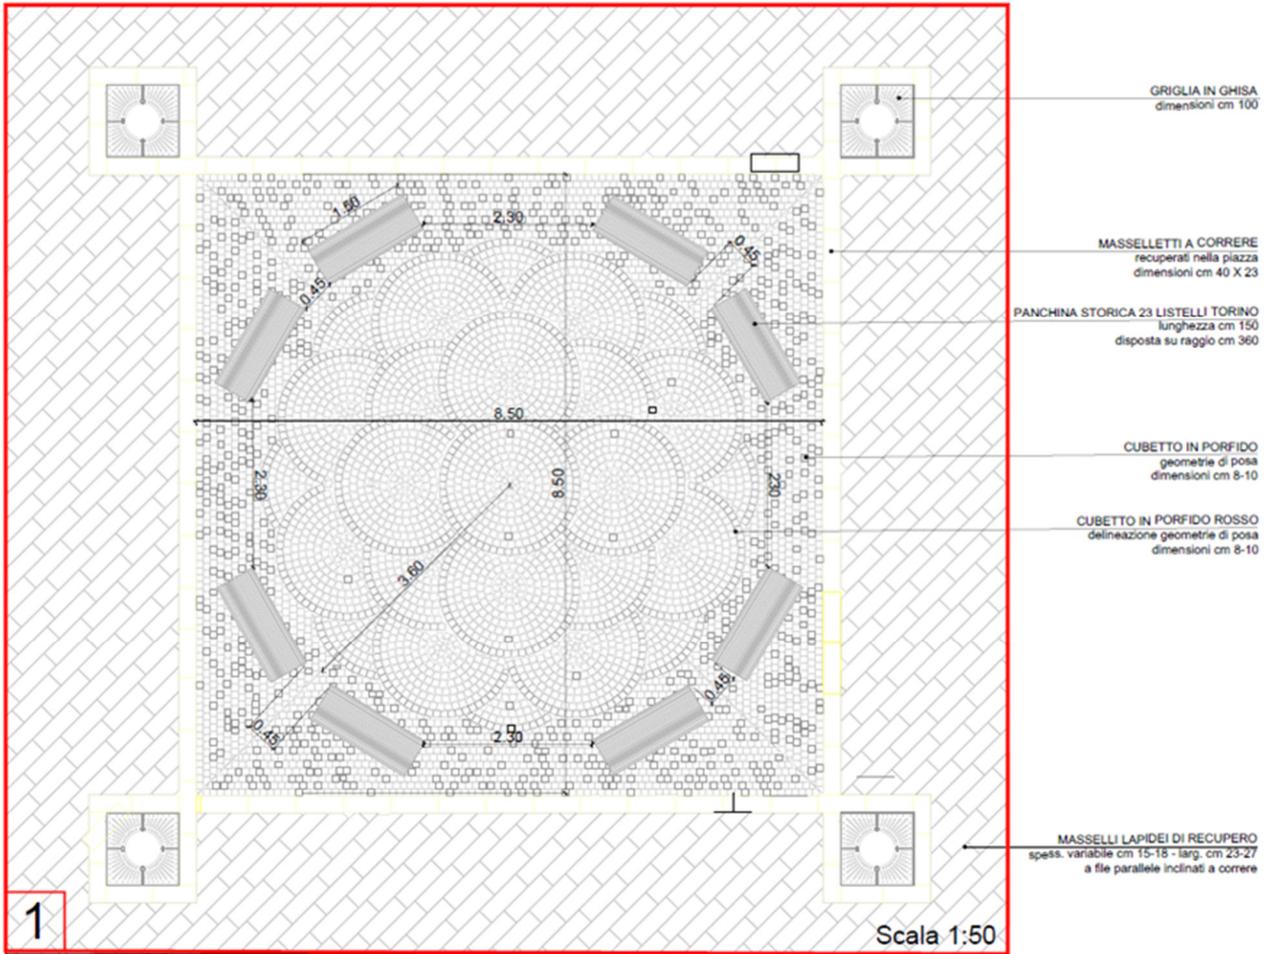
Lotto 1 Piazza particolare 1 pavimentazione
